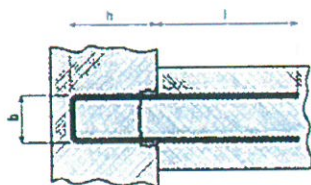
Prętowy element łączący BINDAX do łączenia elementów żelbetowych
